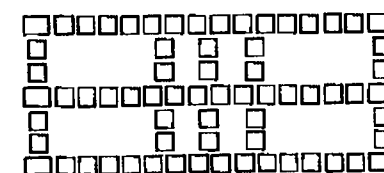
План фундаментов и конструктивные решения продольных стен здания
